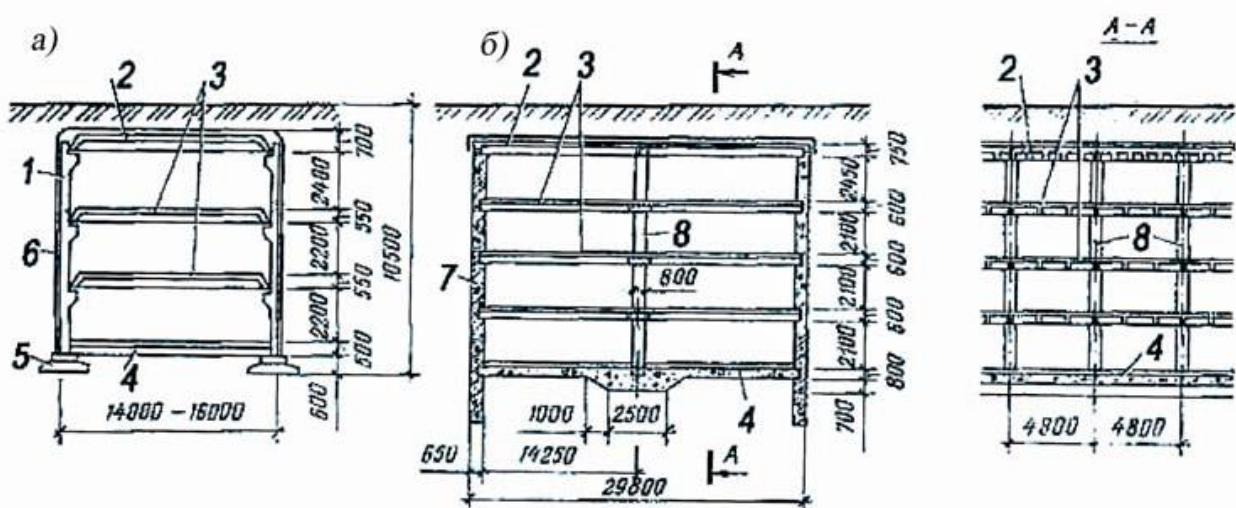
Конструкції підземних гаражів: а – однопрольотна; б – двопрольотна: 1 – стіновий блок; 2 – верхнє перекриття; 3 – між ярусне перекриття; 4 – лоток; 5 – фундамент; 6 – гідроізоляція; 7 – траншейна стіна; 8 – колони
